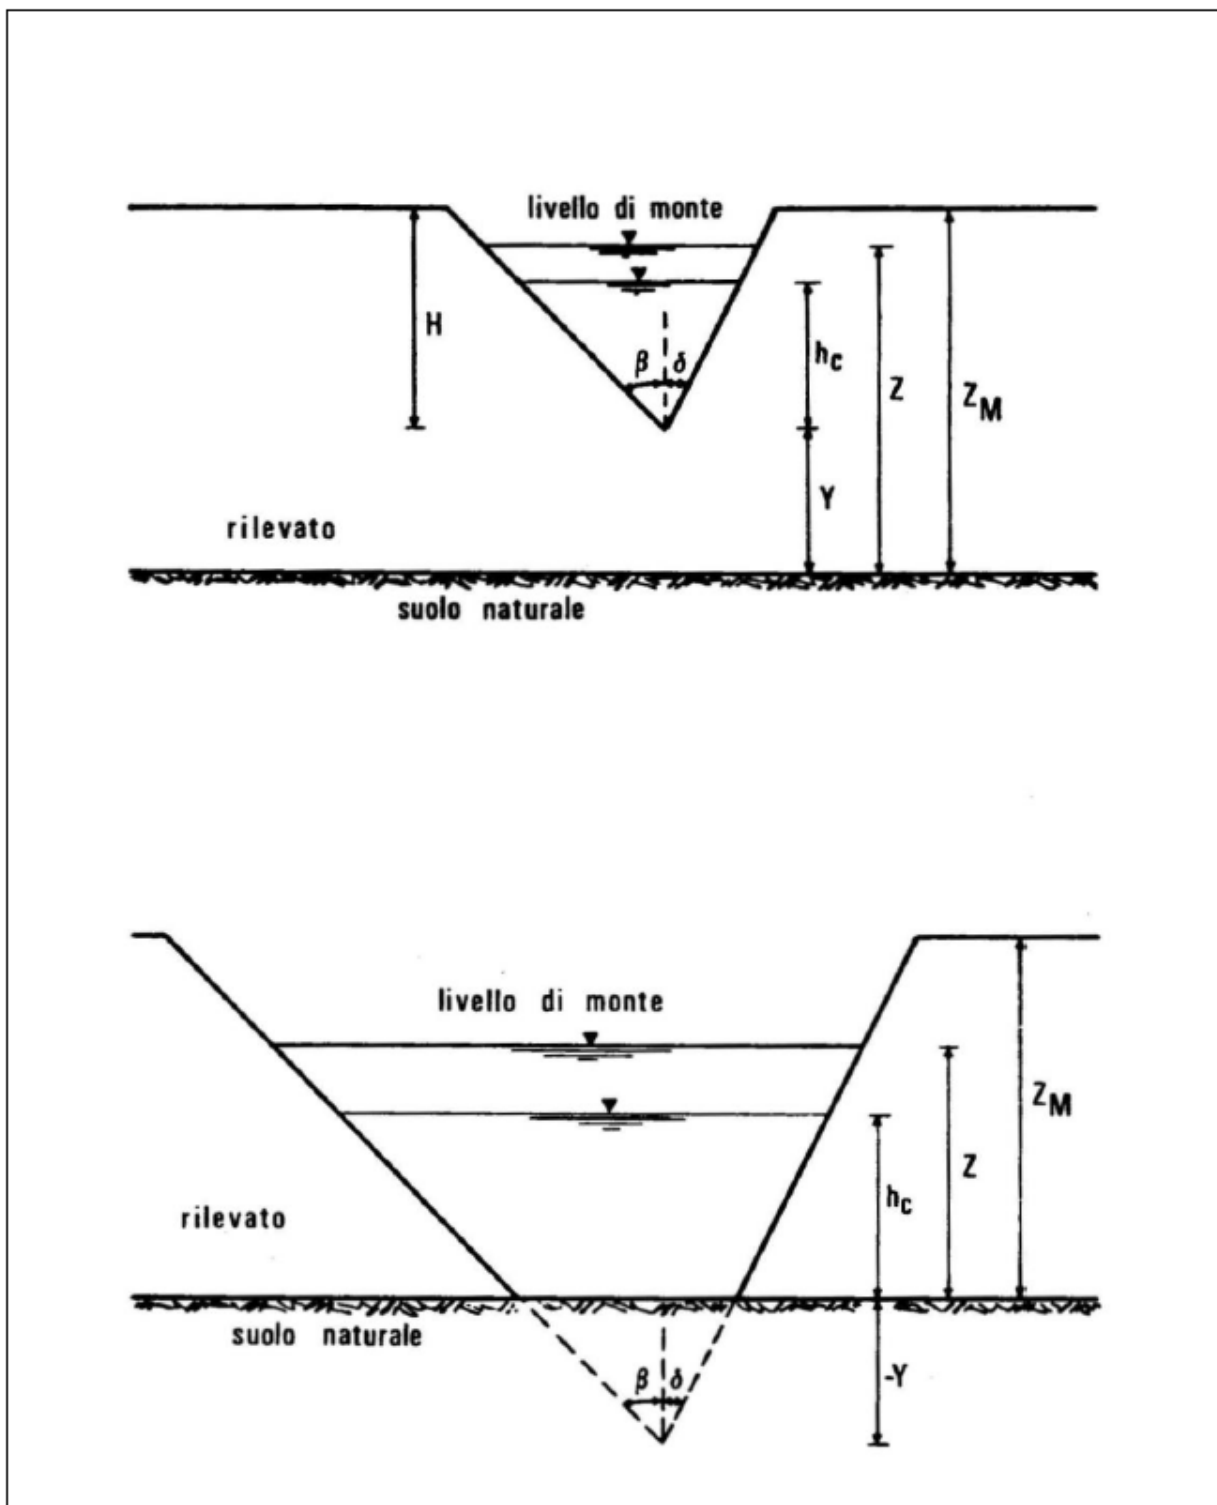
Schema della breccia a soglia erodibile a) breccia triangolare; b) breccia trapezia
